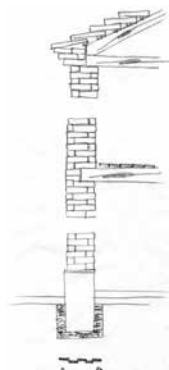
Sistema construtivo em alvenaria de tijolo_ Corte tipo (Carvalho 2006)
